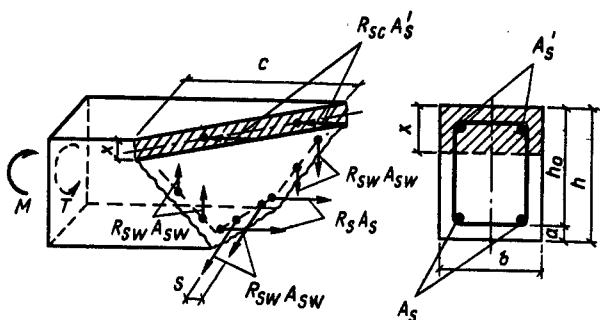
К расчету элементов прямоугольного сечения, работающих на изгиб с кручением (1-я схема расположения сжатой зоны)
